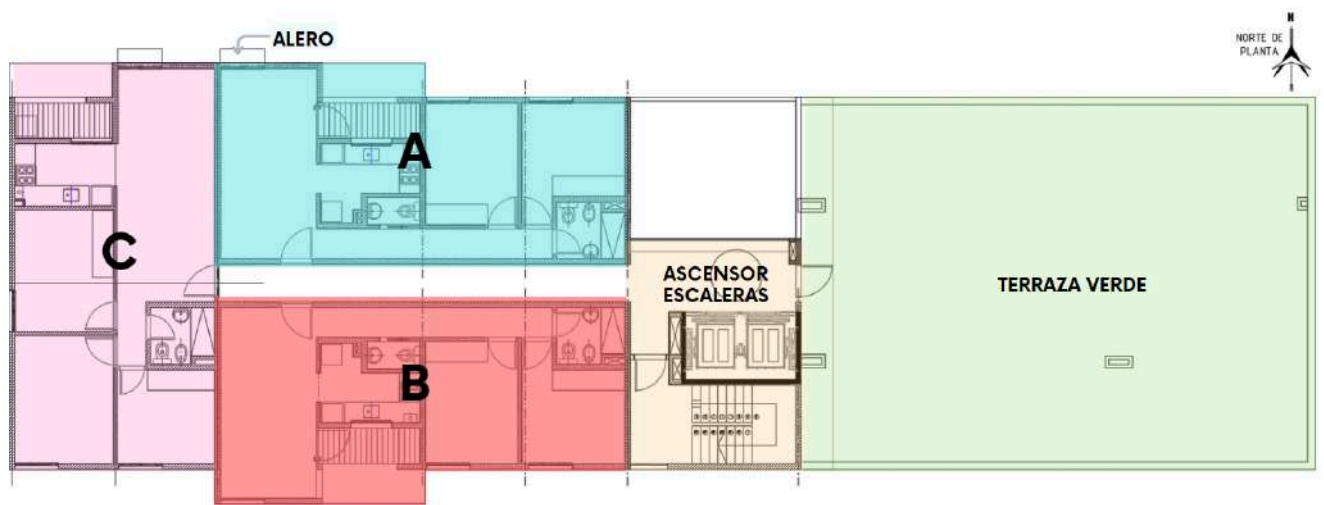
Planta de Arquitectura del último piso del edificio.
